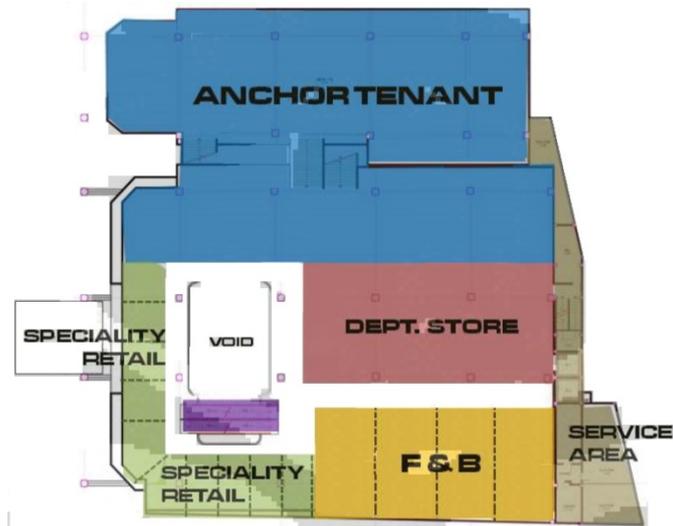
Denah basement alternatif konsep pengembangan Mal Mitra 2
